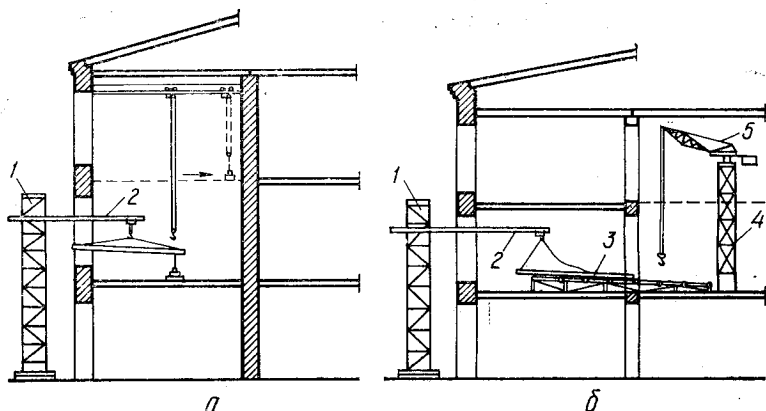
Схемы организации демонтажно-монтажных работ подъемником КП-0,6:
